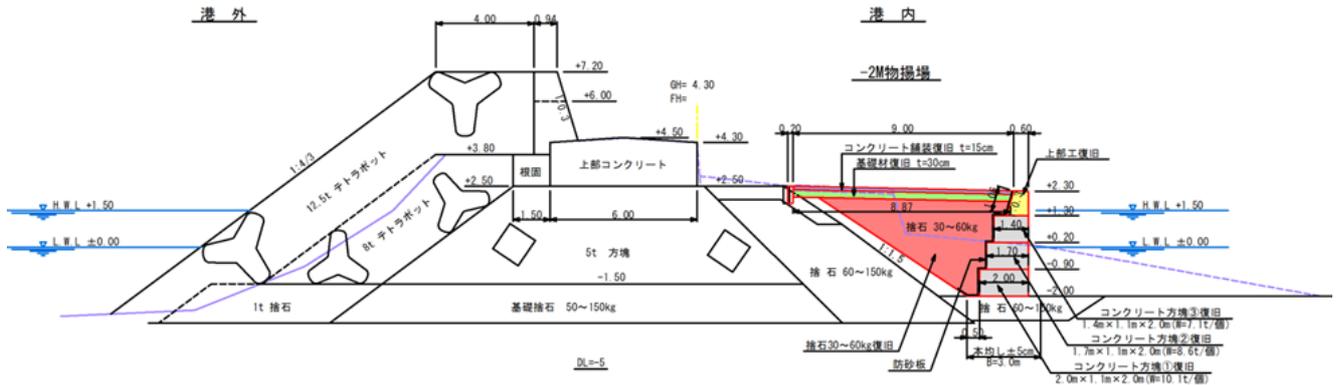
No.25 大洗港区_第1埠頭地区 B 物揚場 (-2m) の断面図 (復旧後)
